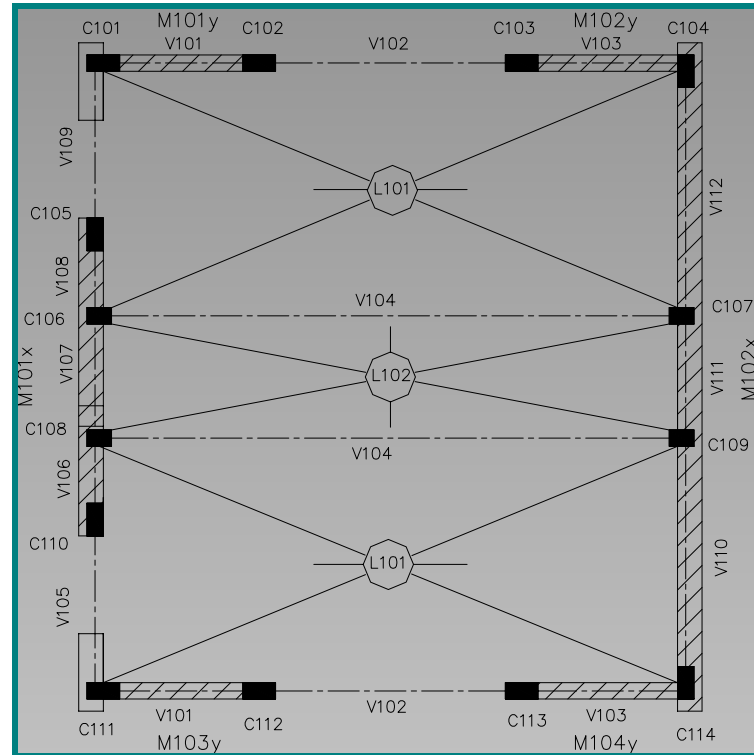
b: Planta de estructura del 1º nivel.
